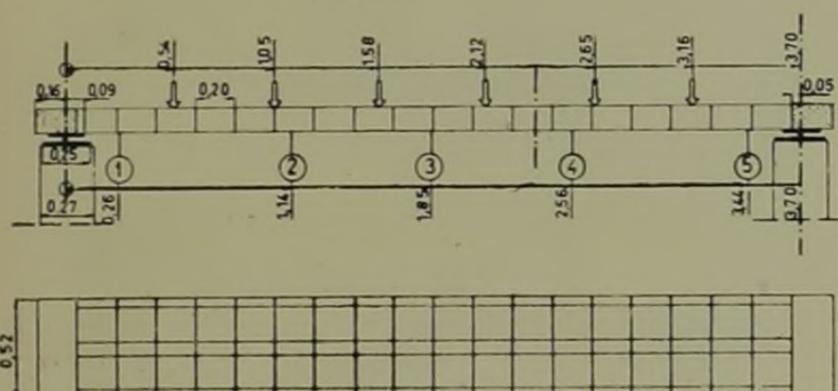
Alzado, planta y corte de la pieza ensayada.
